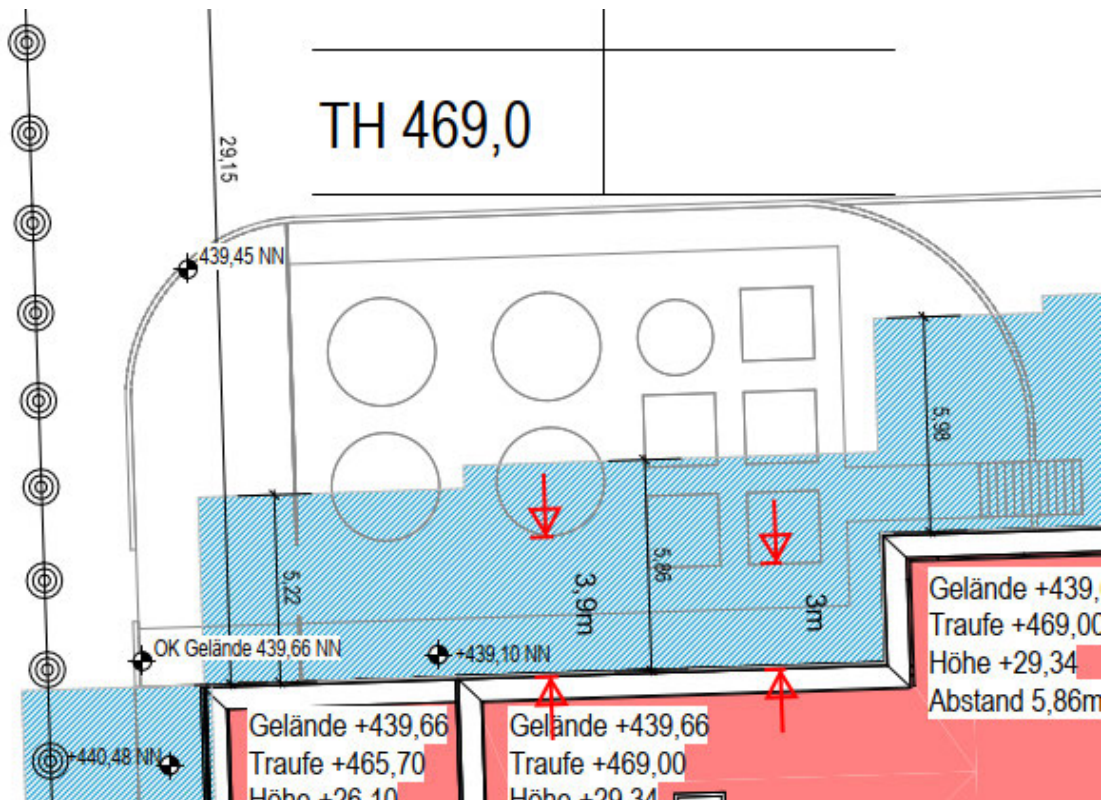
Auszug aus Lageplan mit Abstandsfläche
